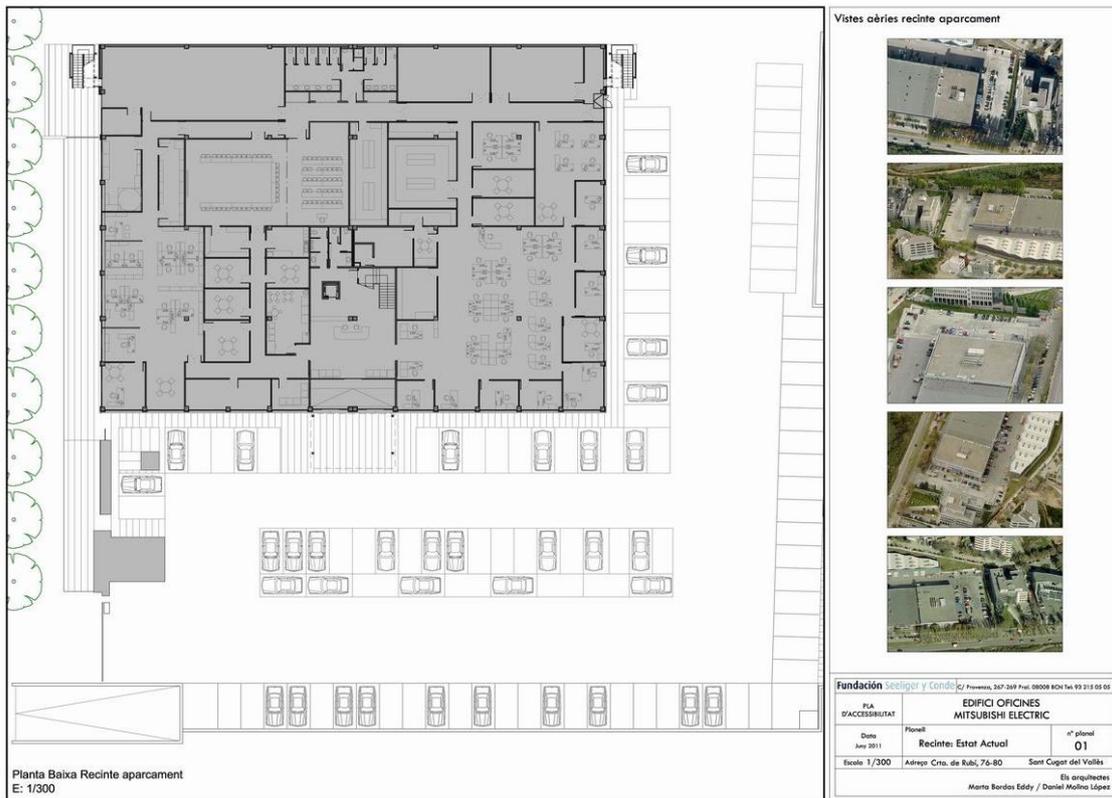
Edificio Oficinas MITSUBISHI ELECTRIC. Planta estado actual Zona Parking.
